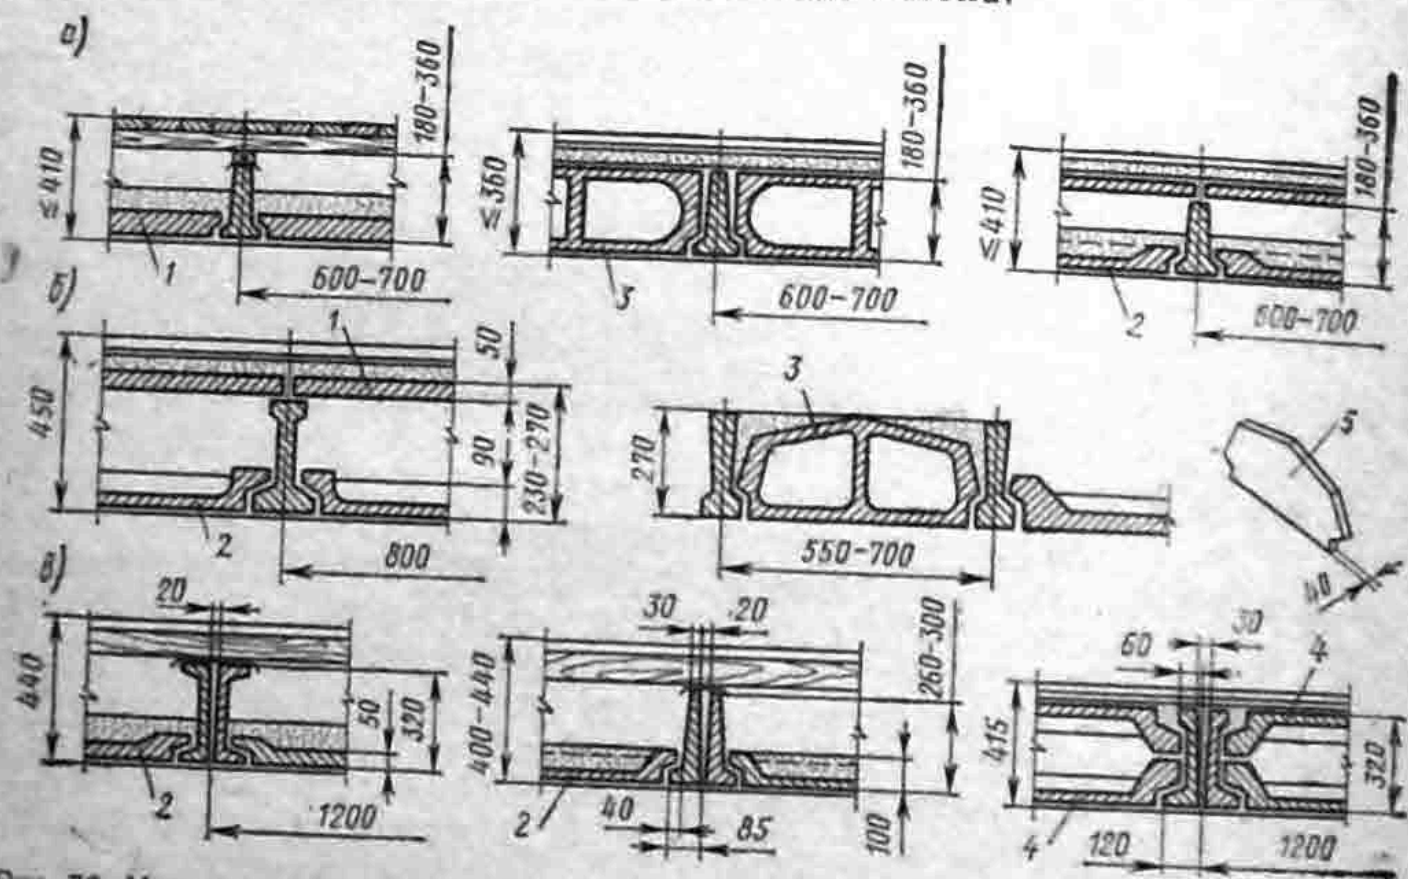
Междуетажные перекрытия из среднеобъемных деталей (балок и наката между ними):
